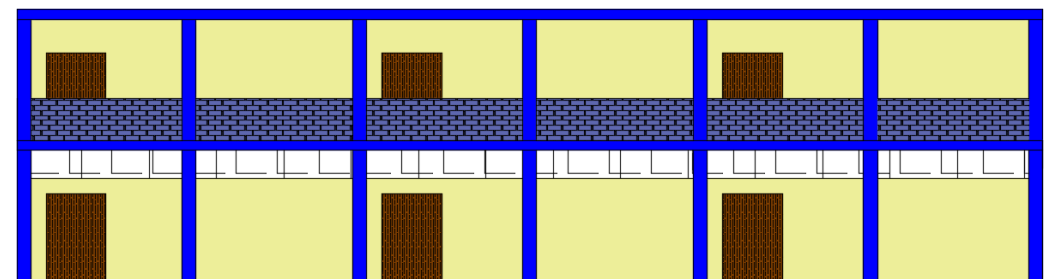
Elevación interior del pabellón de la I E Santa Fortunata
